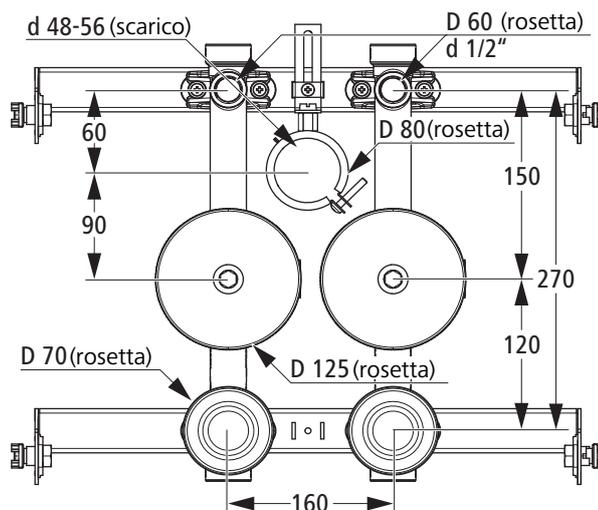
Misure di montaggio del lavabo set sotto muro Optivis-Tec, distanza delle dime set di montaggio valvola sotto muro = 160 mm
